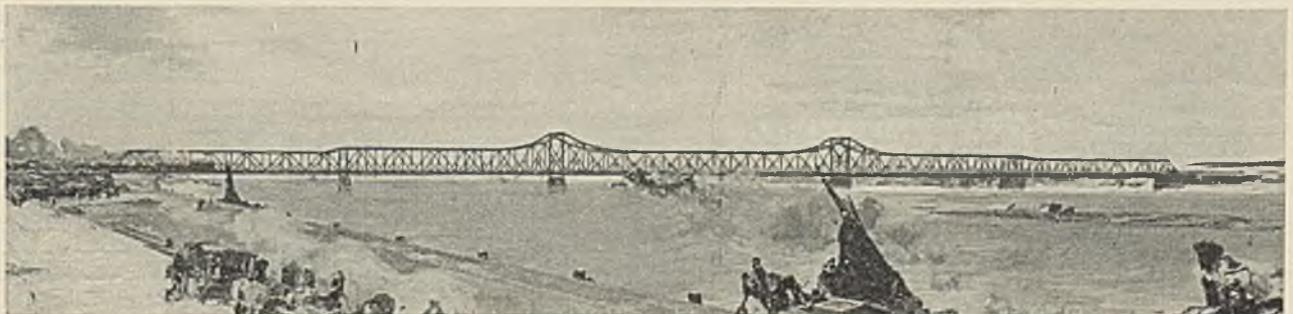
Eisenbahn- und Straßenbrücke über die Save bei Schabaz.
